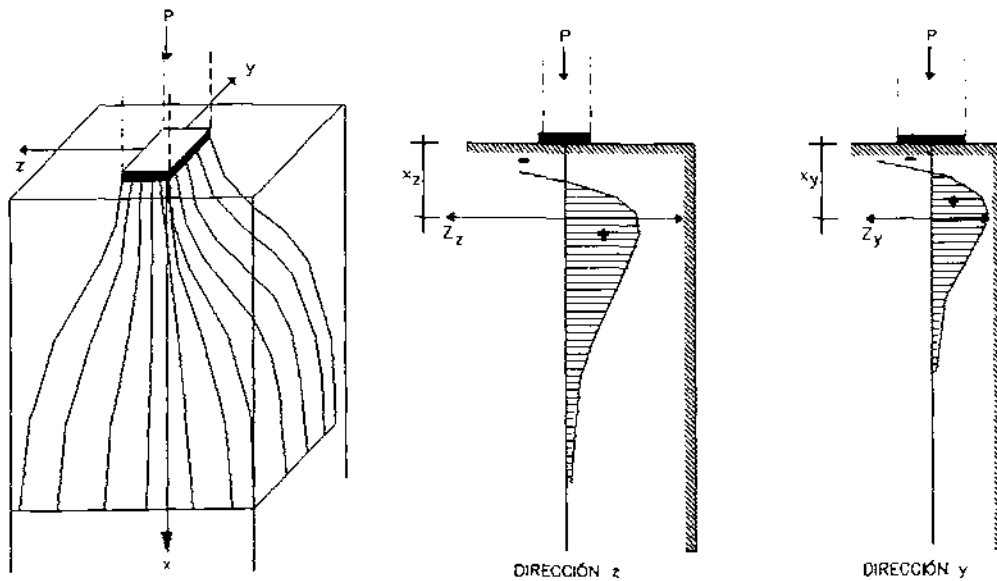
Distribución tridimensional de tensiones en un muro de sótano, por la acción de pilares de fachada.
